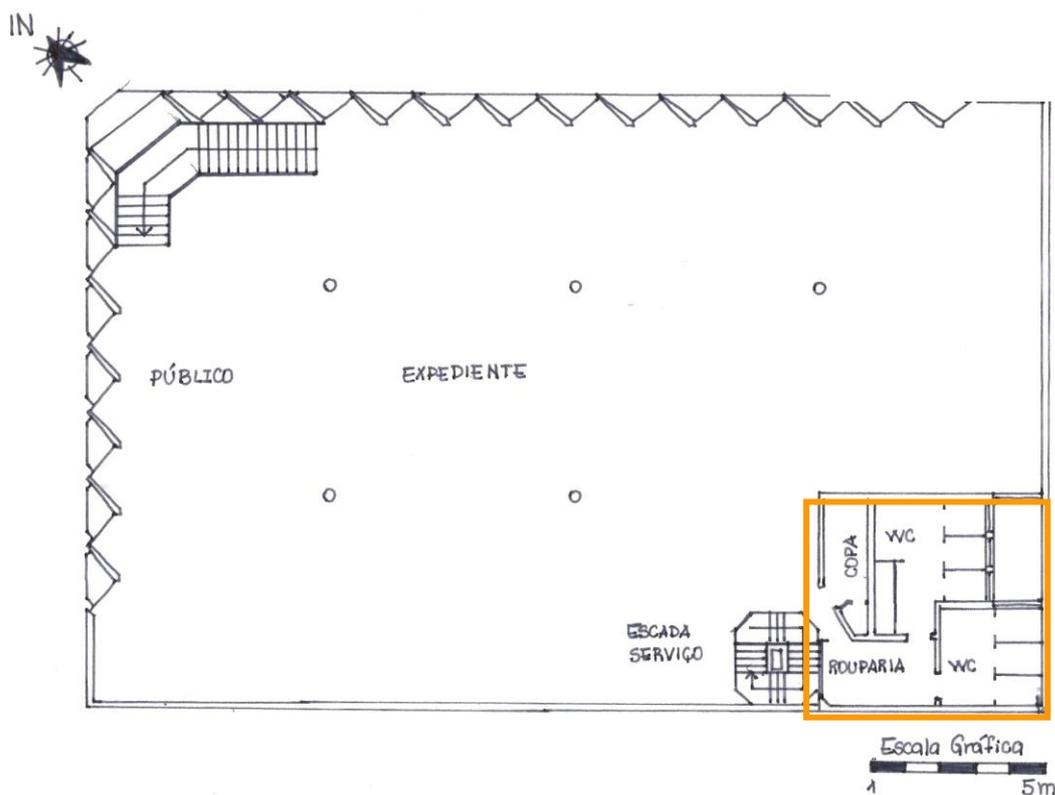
Planta baixa esquemática da edificação – Primeiro Pavimento.
